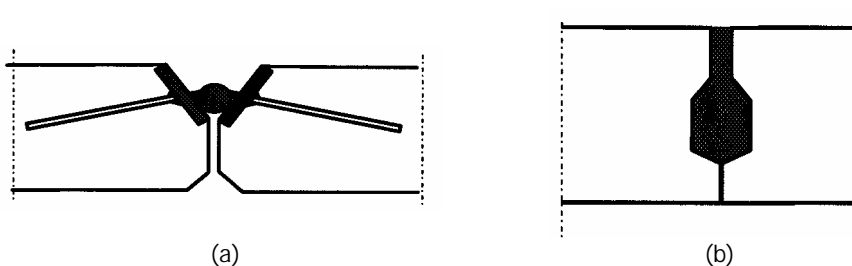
ligações soldadas e grauteadas entre os elementos de piso em duplo-T
